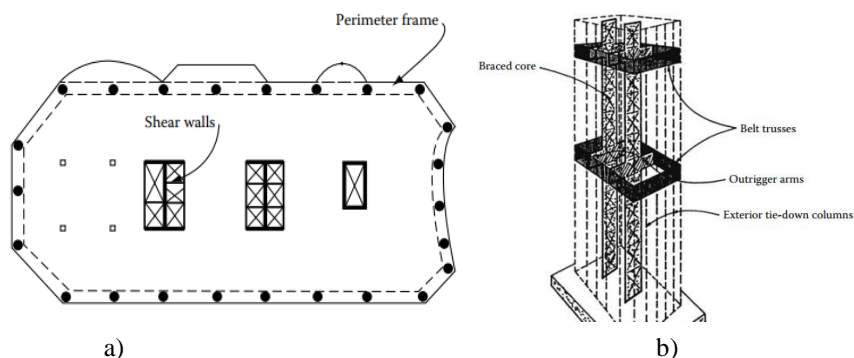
a) Pilar-parede com pilares no perímetro; b) Outriggers e belt truss
